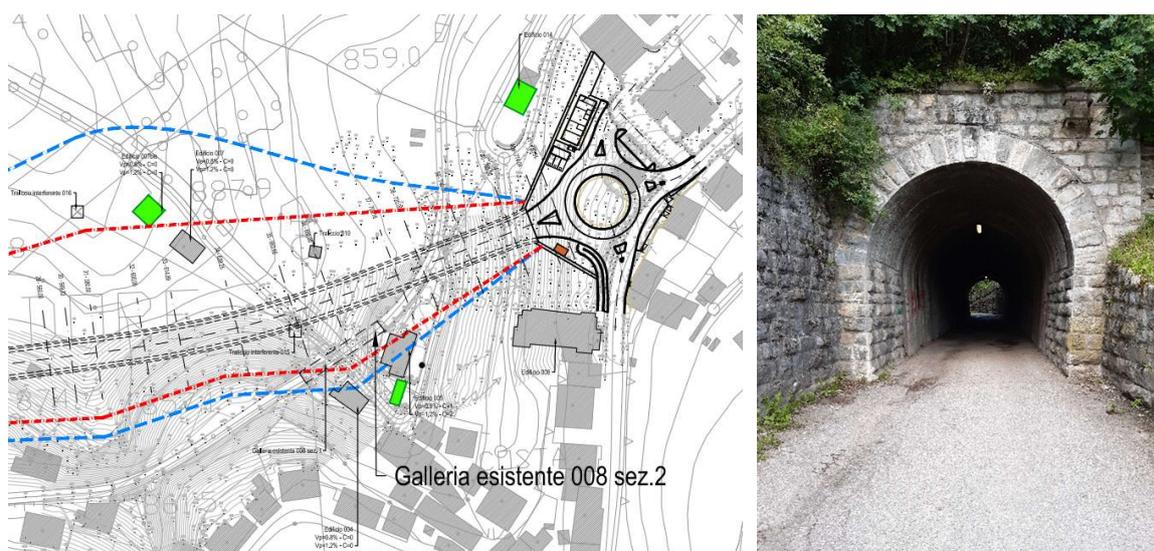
Planimetria tracciato con galleria esistente in muratura
